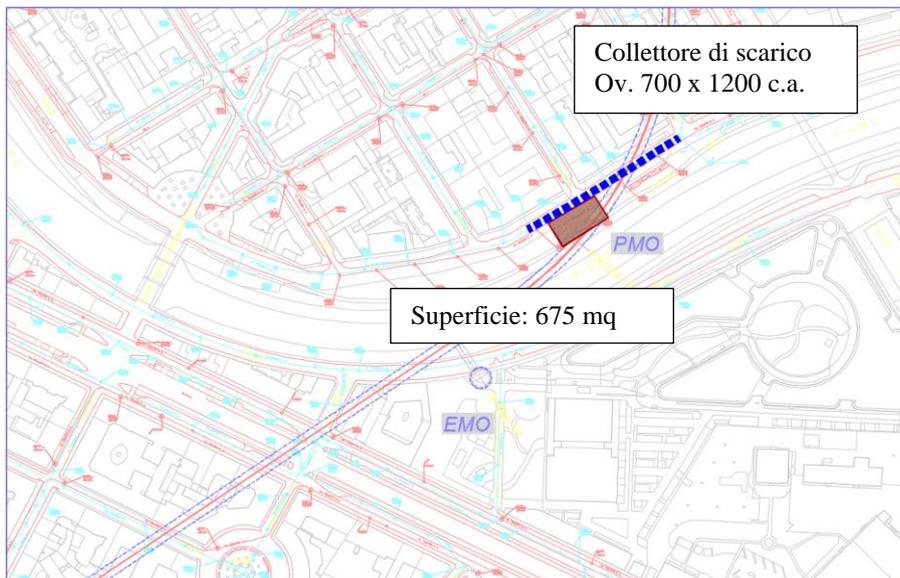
Aree di cantiere – Pozzo PMO – FASE UNICA
